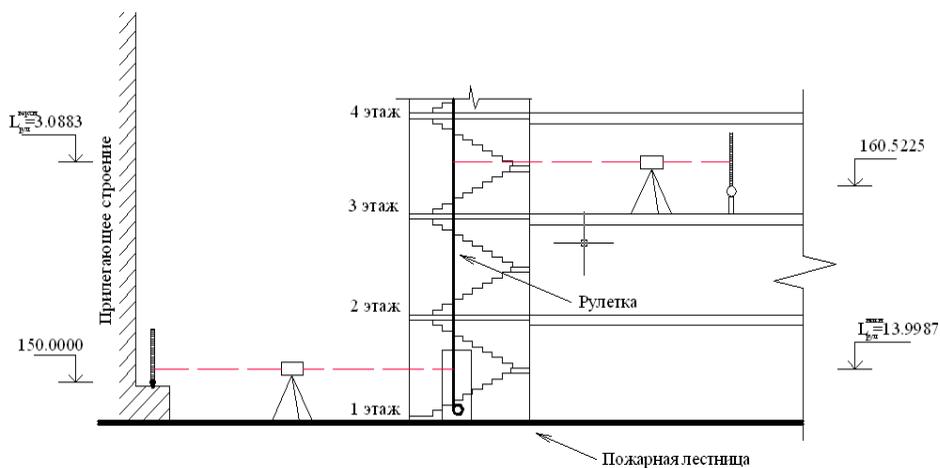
Схема передачи отметок с улицы на 3-й этаж здания
